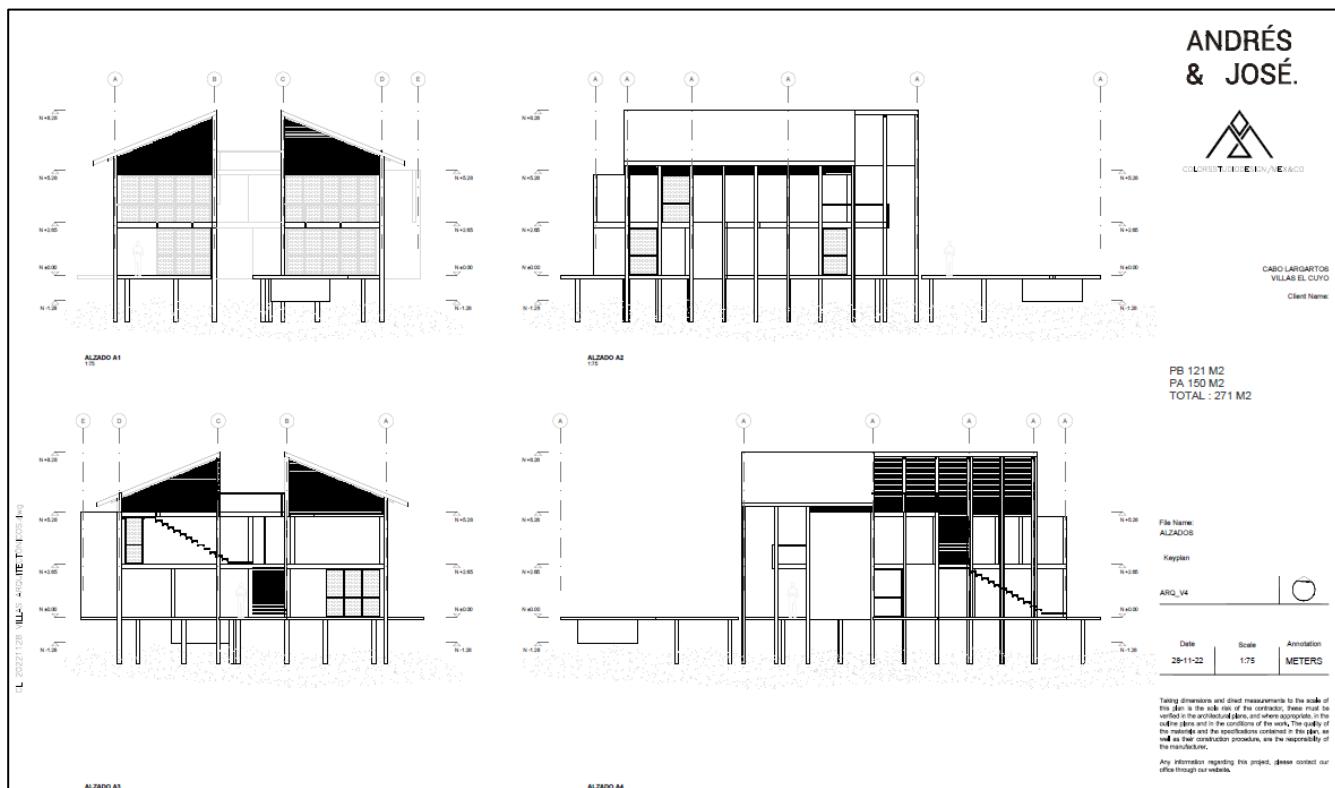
Cabañas y glampings con cimentación piloteada.
